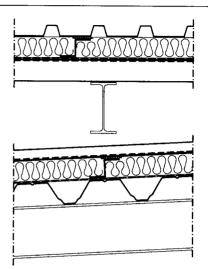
Zweischaliges wärmegedämmtes nichtbelüftetes Trapezprofildach (Binderkonstruktion) Distanzprofile diagonal verlegt
